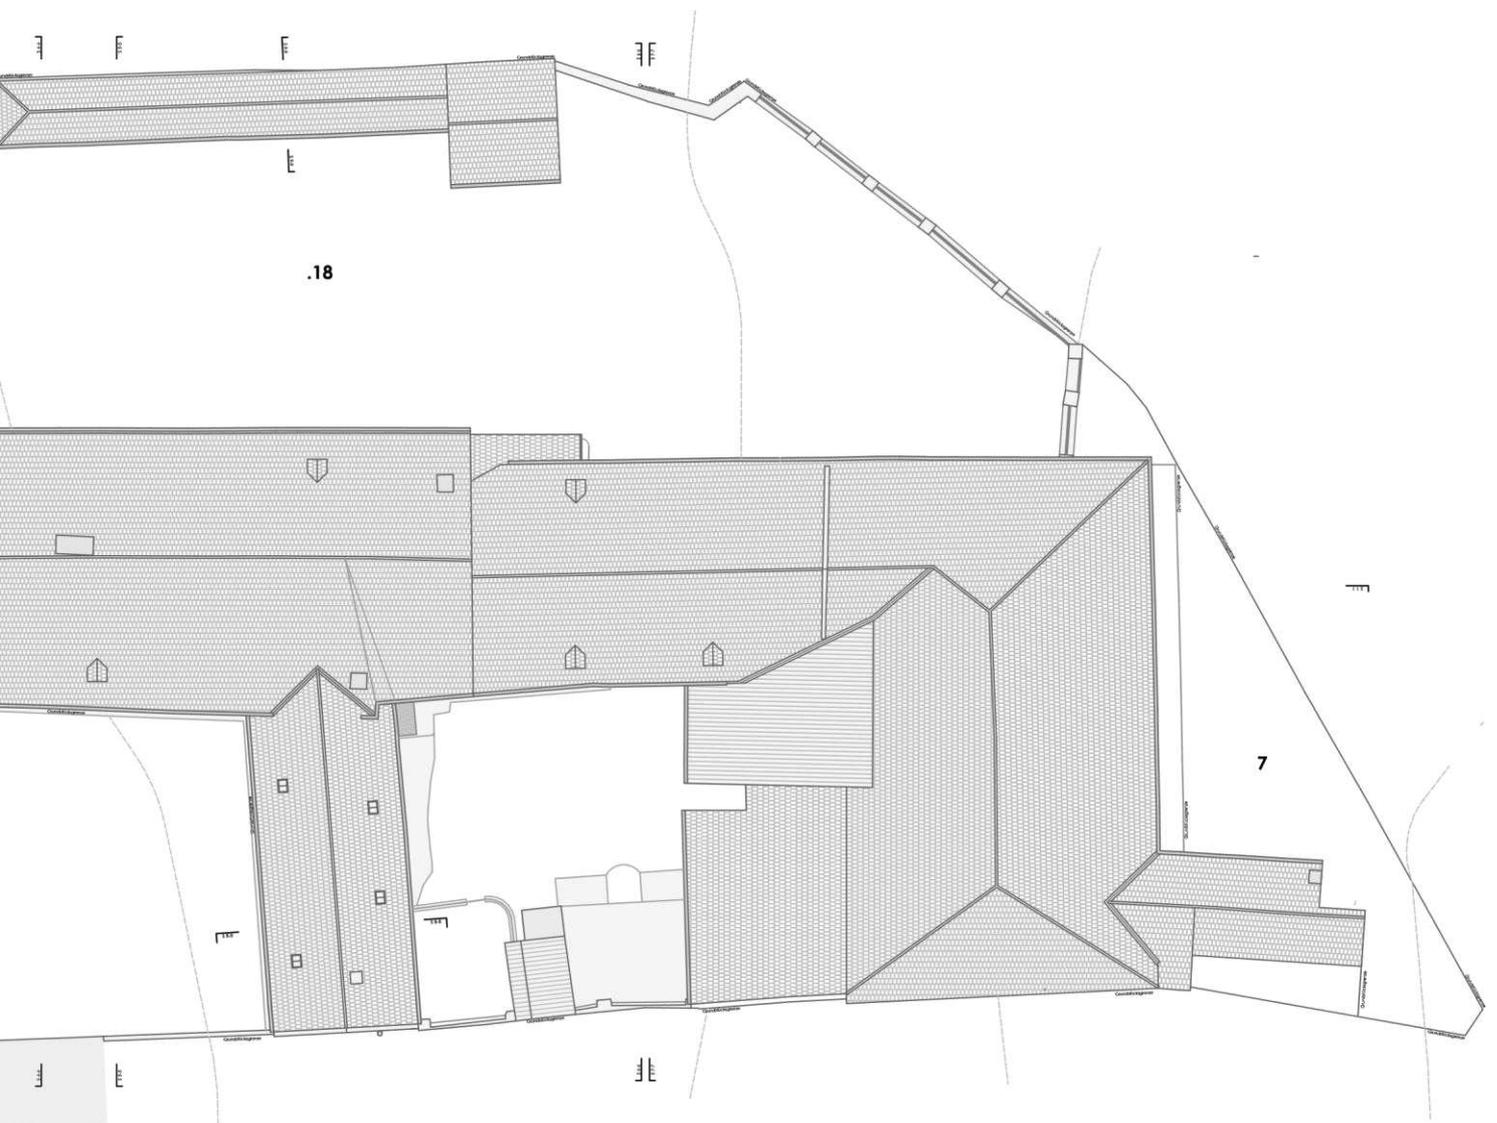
Bestandsplan Grundriss Dachdraufsicht- Übersichtsplan
